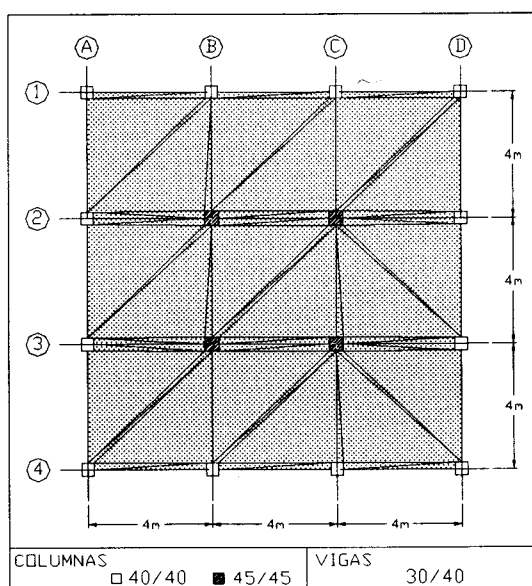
Distribución en planta de una edificación de 4 pisos de Hormigón Armado
